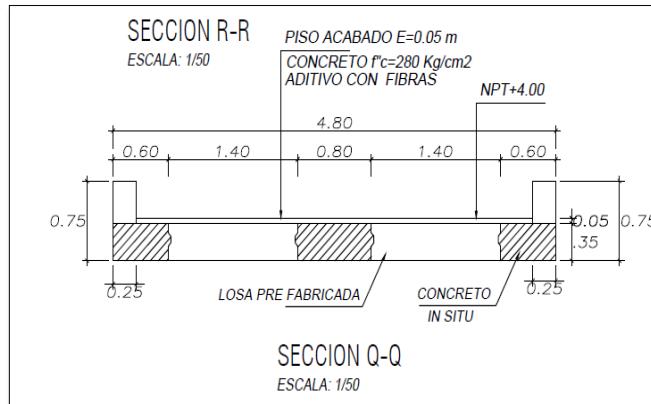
Muestra de sección transversal de 2 vigas horizontales.
